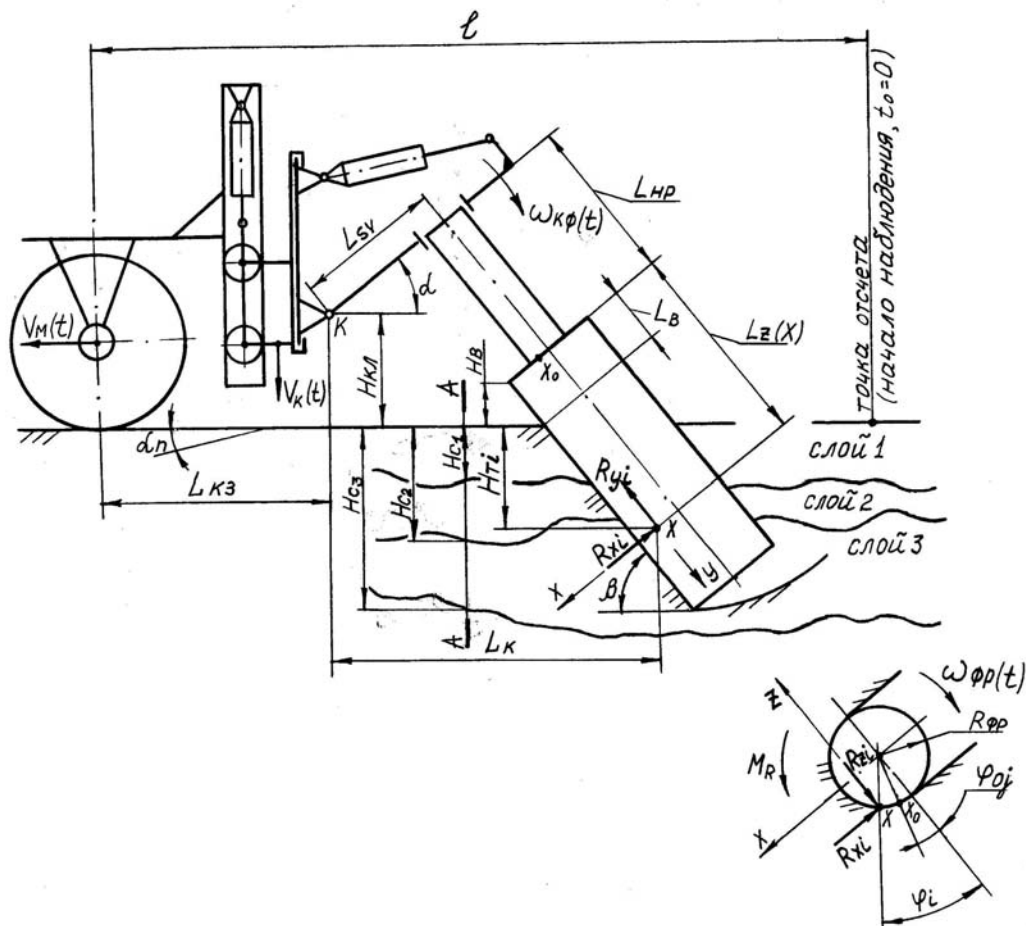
Расчетная схема для определения компонент сопротивления грунта разрушению резцом траншекопателя в условиях слоистого анизотропного грунта в забое
